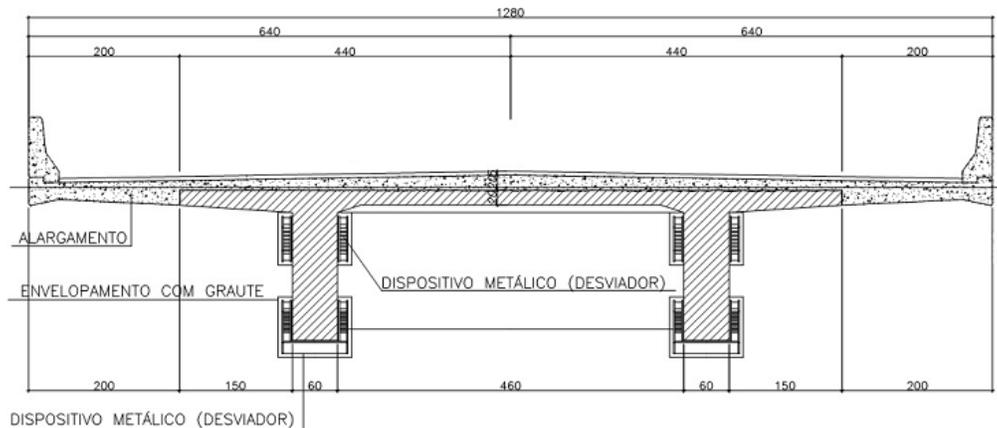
Seção transversal após alargamento com protensão externa, quando não há a adição de novos pilares (VITÓRIO. (2013)).
